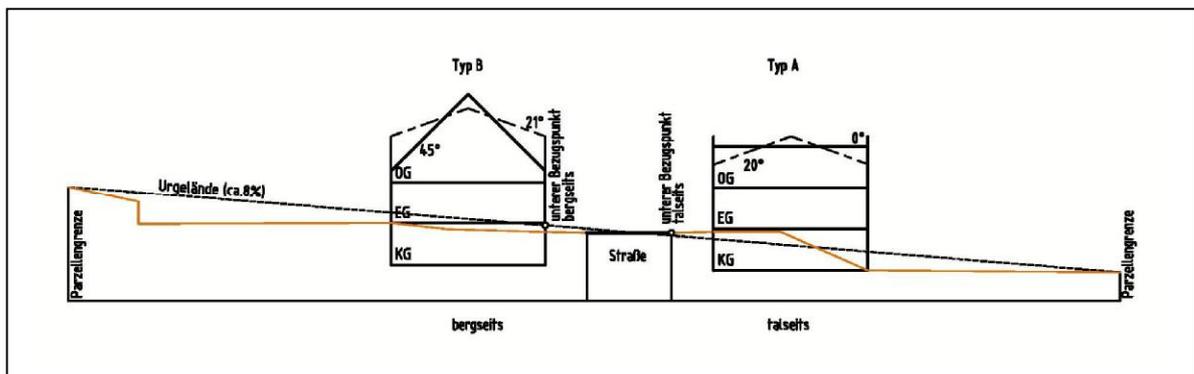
Schemaschnitt mit Höhen, Bezugspunkten und möglicher Geländegestaltung – unmaßstäblich
